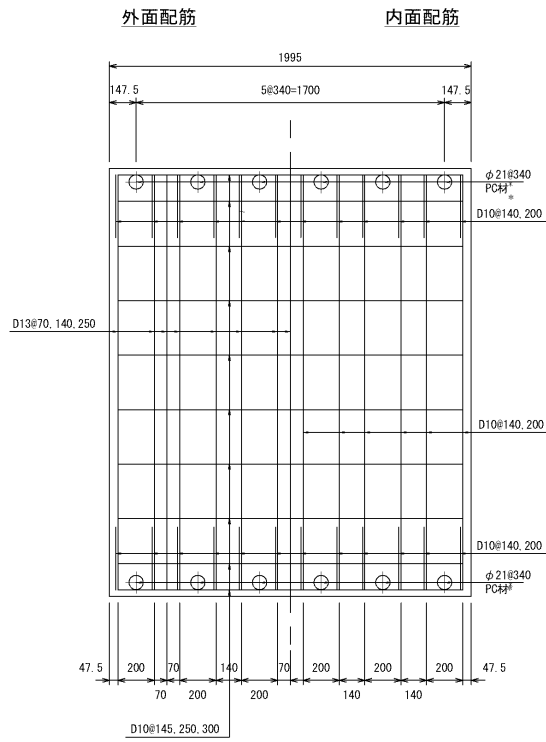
(1) 屋外排水路 (防波壁横断部) の概略配筋図
